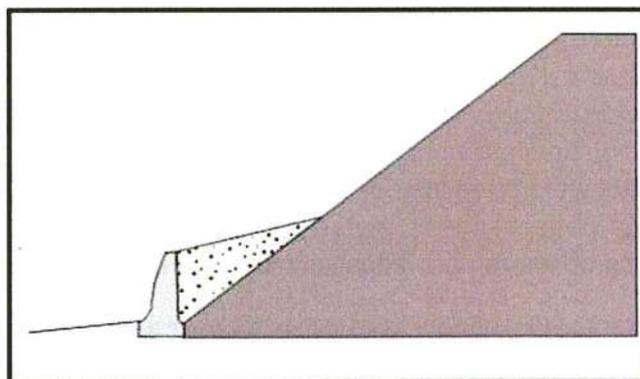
Relleno estabilizador sostenido por el muro (INGEMMET, 2000)
